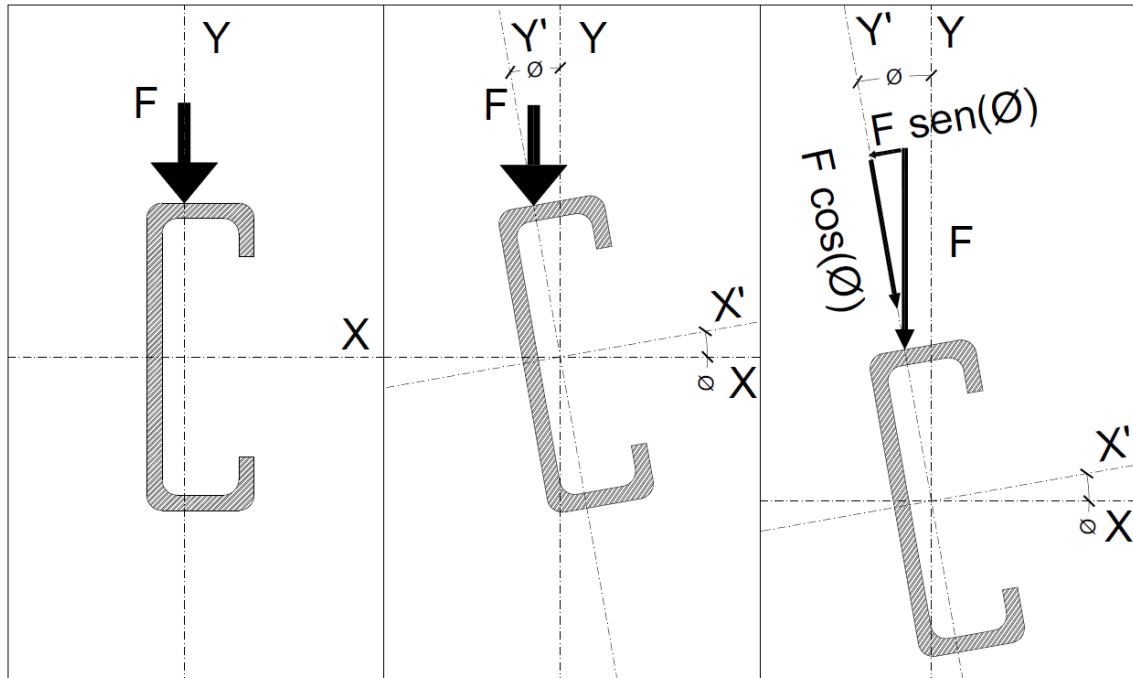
Descomposición de fuerzas en flexión asimétrica.
